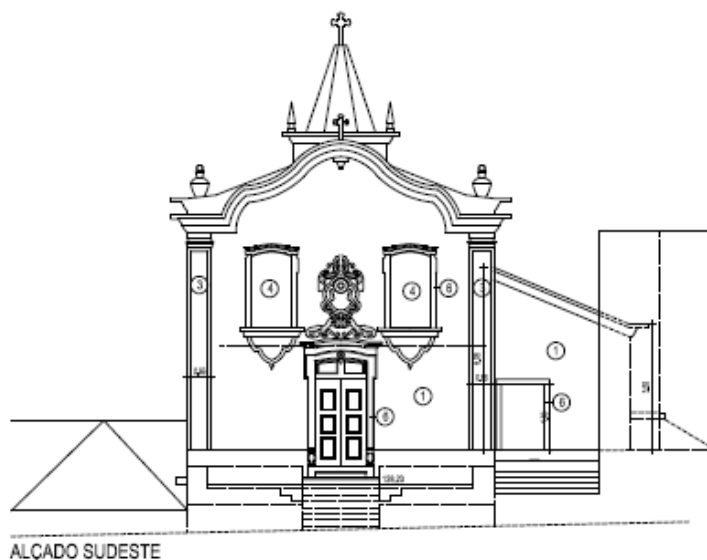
Alçado com as alterações propostas, rebaixamento do telhado. [9]
